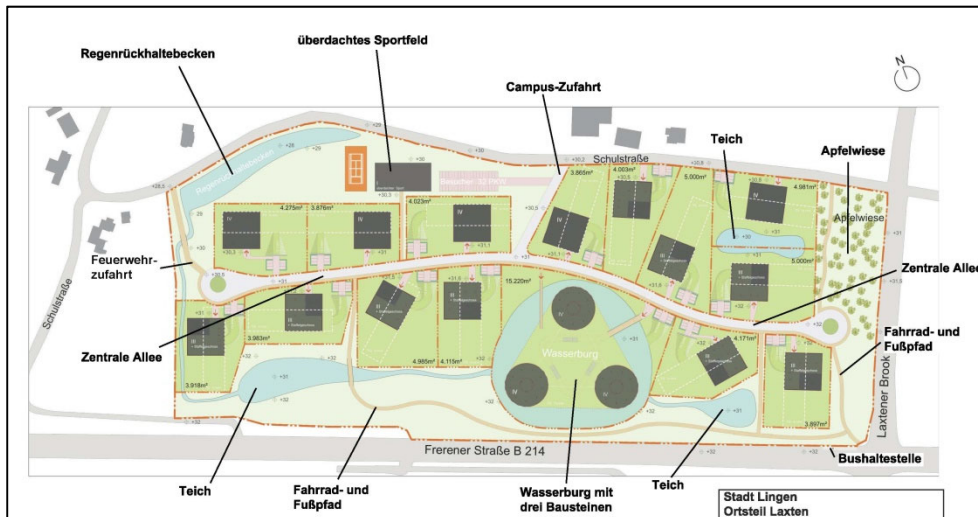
Lageplan - IT-Campus Lingen (ICL)
